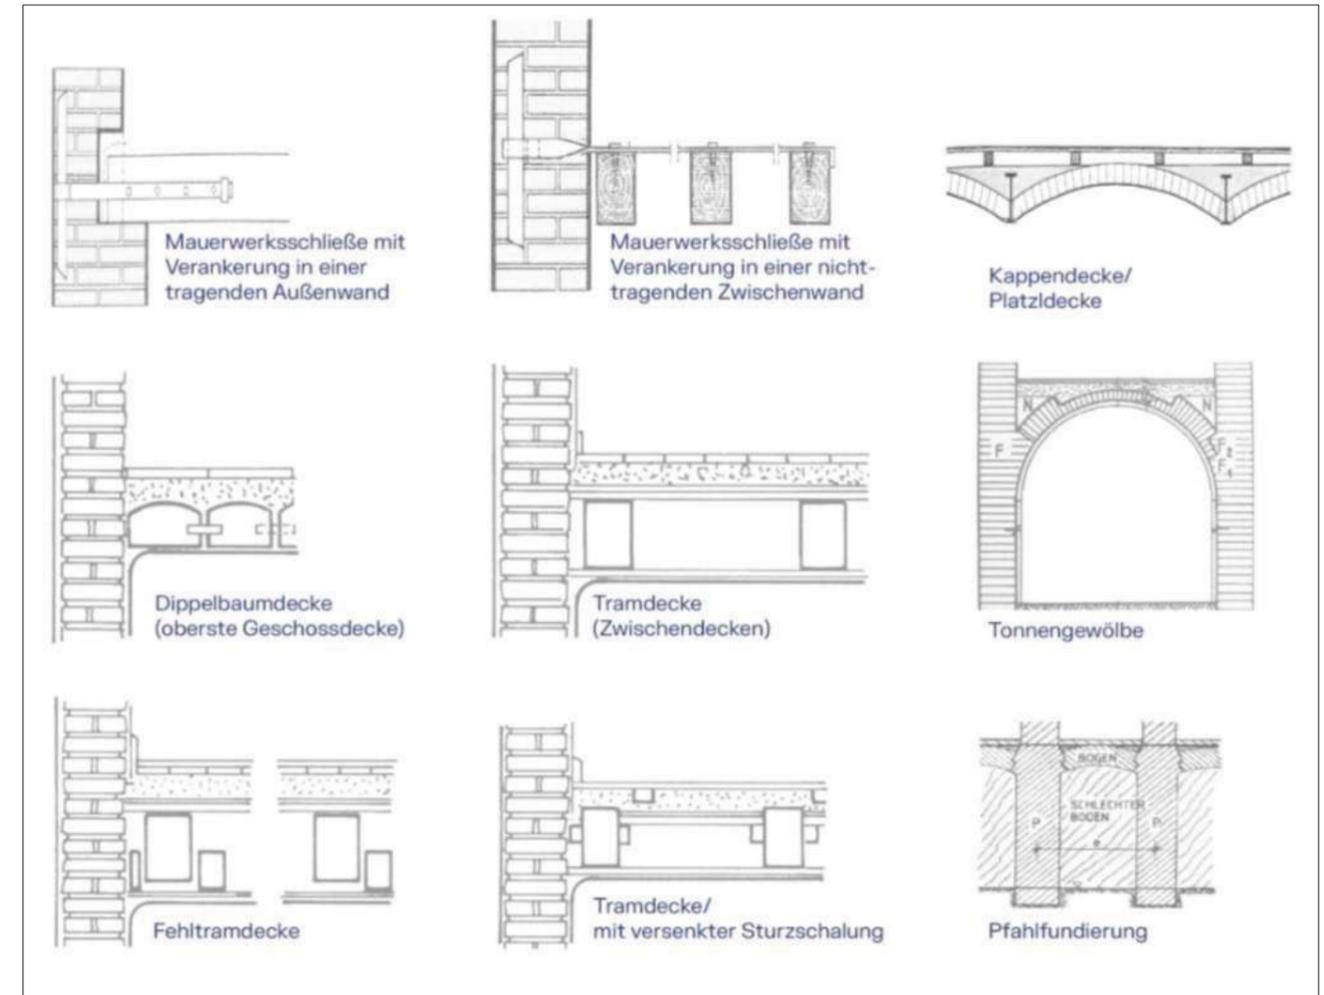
Details von Decken, Böden, Fundamenten und Verbindungen von Wand und Decke in einem typischen Gründerzeithaus © Andreas Kolbitsch, Bautechnische Analysen und Statik historischer Baukonstruktionen, Wien 2015
